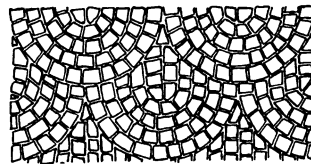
Kleinpflaster, bogenförmig verlegt.
